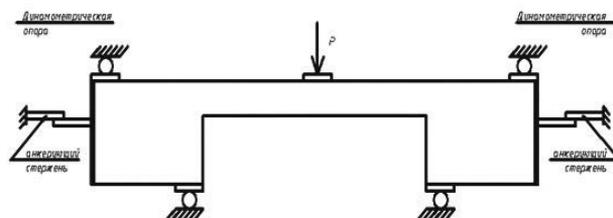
Схема испытания фрагмента неразрезного перекрытия
